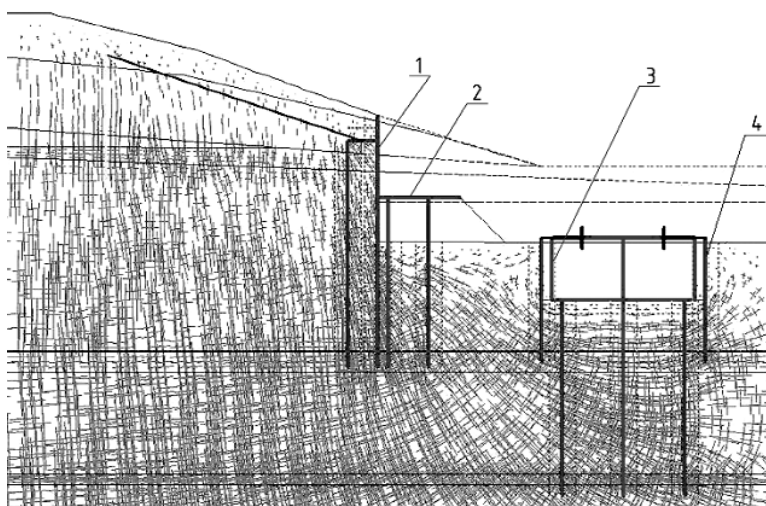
Розрахункова схема з влаштування котловану "холодної зони" зі шпунтовою огорожею і виконання залізобетонних конструкцій всередині котловану після розробки ґрунту під плитою естакади:
